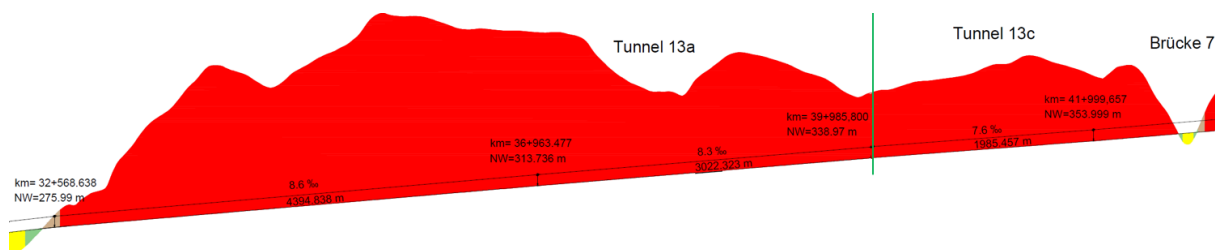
Längsschnitt der Antragsvariante, Abschnitt Tunnel 13a bis Portal Tunnel 13c
